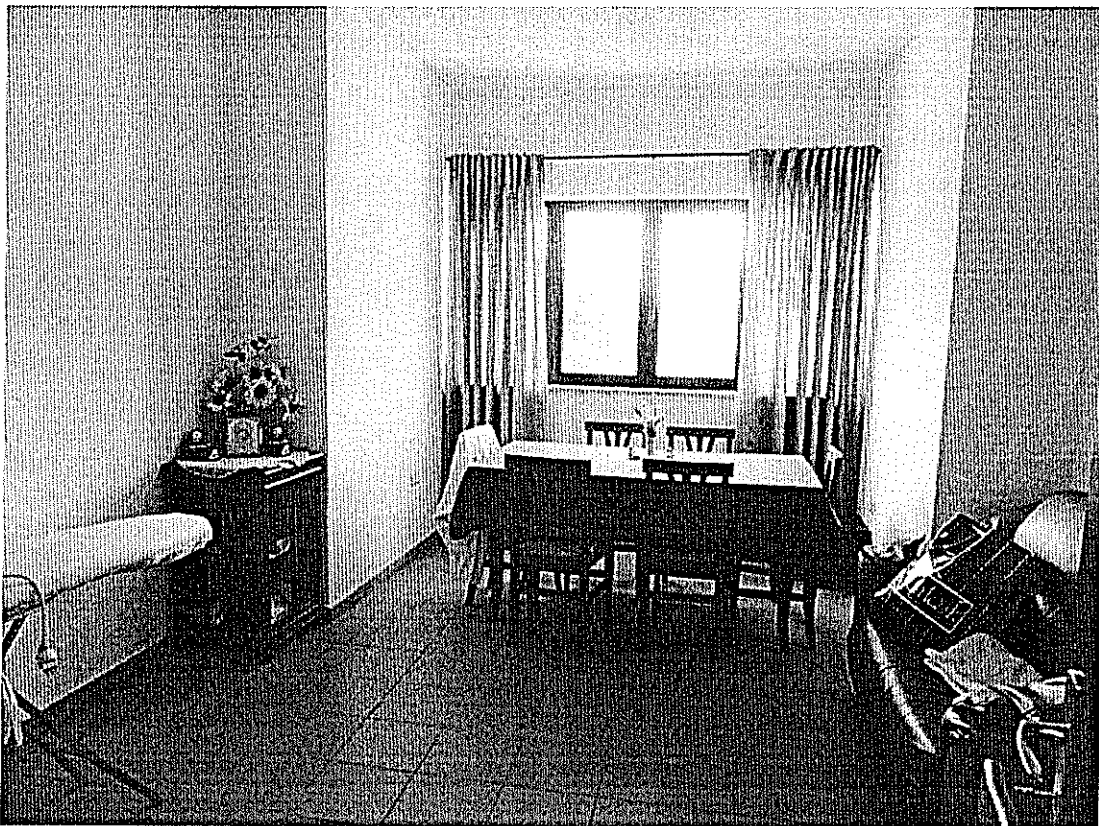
Guardaroba dell'ala sud del primo corpo di fabbrica – piano primo.
